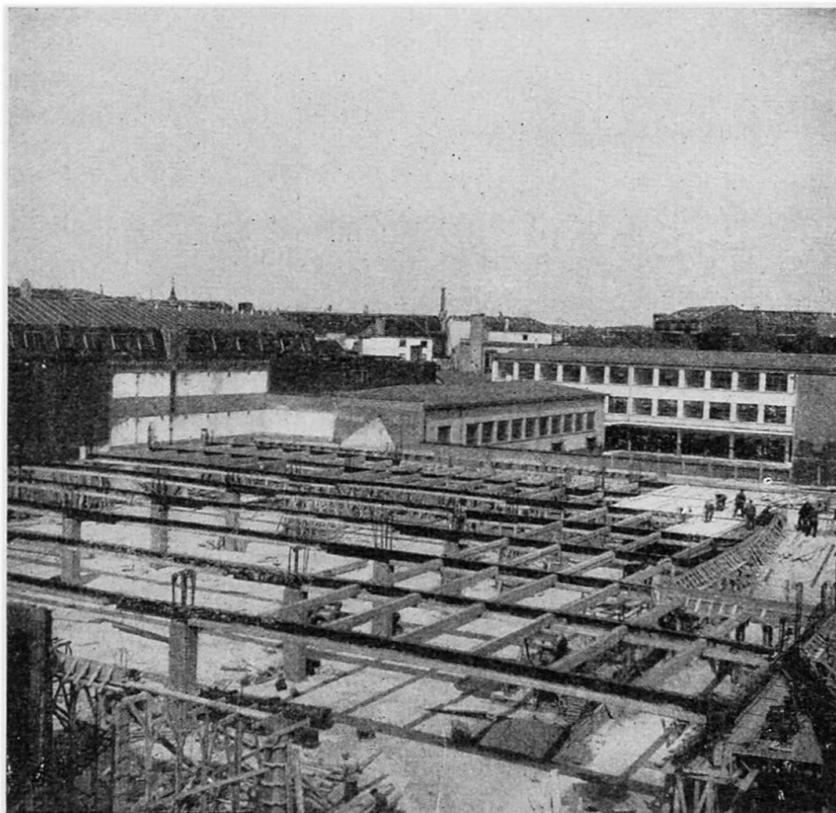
Grand Garage du Vieux Marché aux Grains à Bruxelles.* Mise en place des poutres secondaires préfabriquées en béton armé sur les semelles des poutres Préflex de 20 m. Les coffrages de la dalle coulée sur place, s'appuyent sur les poutres secondaires de 6,60 m.
